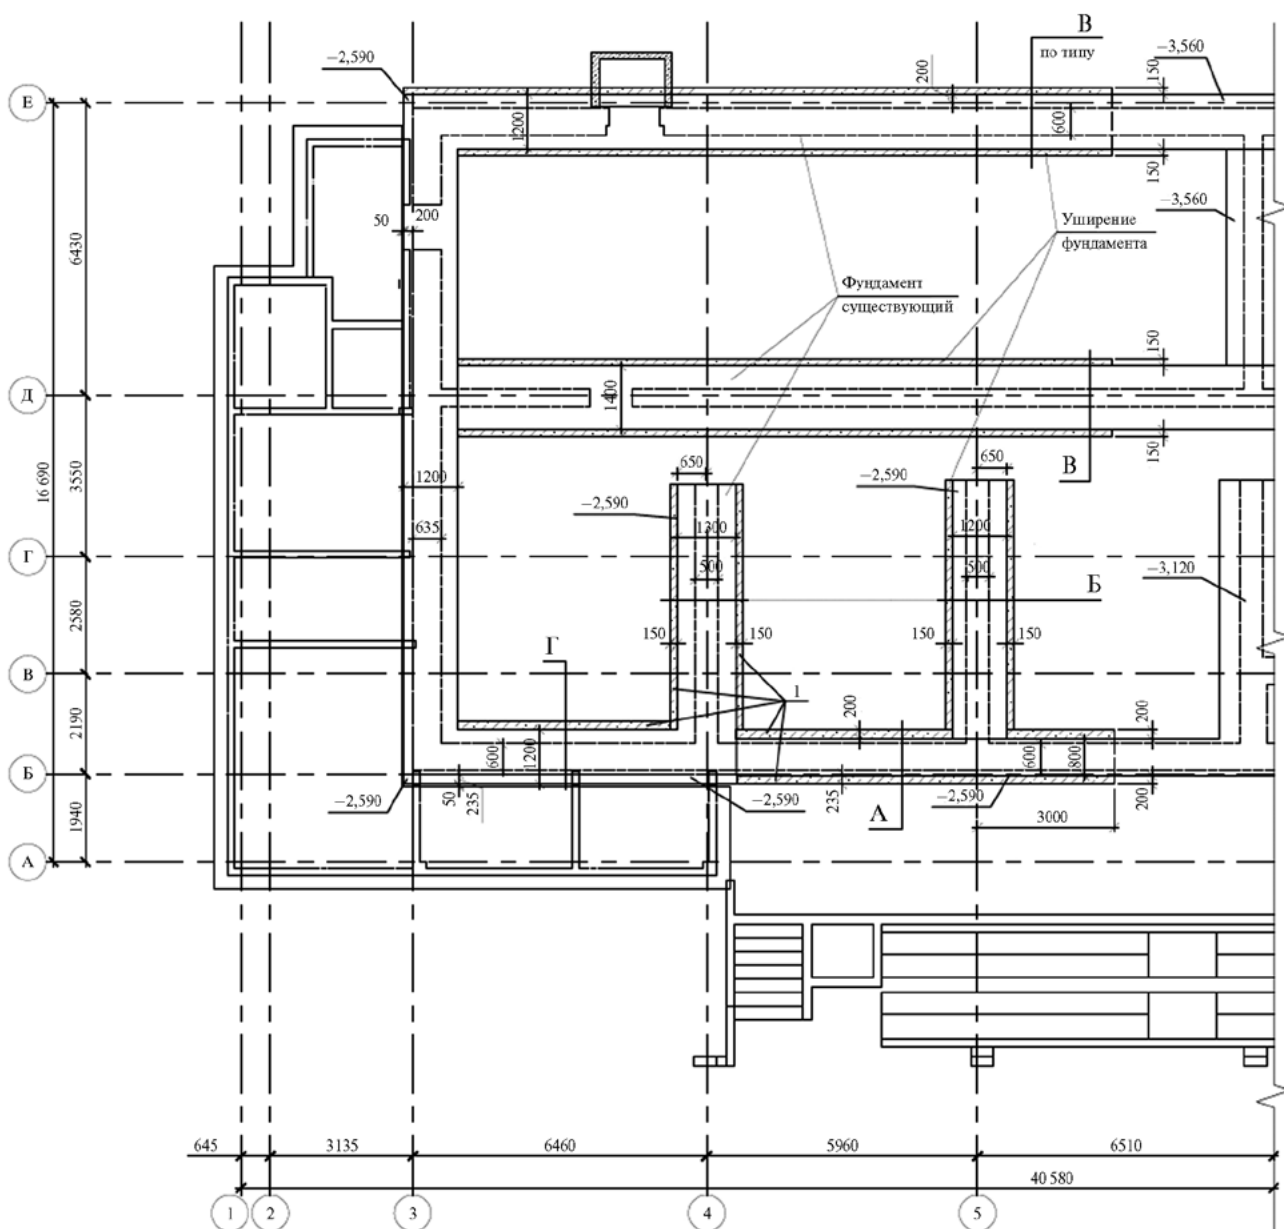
Фрагмент плана усиления существующих фундаментов
